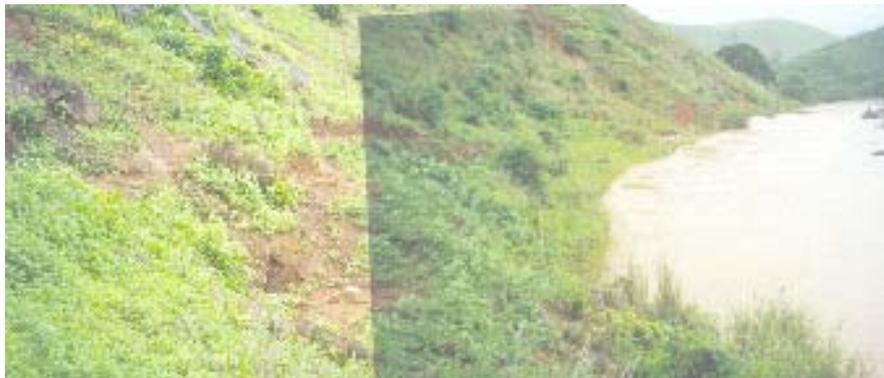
Eixo da Barragem – Vista de jusante para montante, marco da sondagem SR06 - PCH Pirapetinga.
